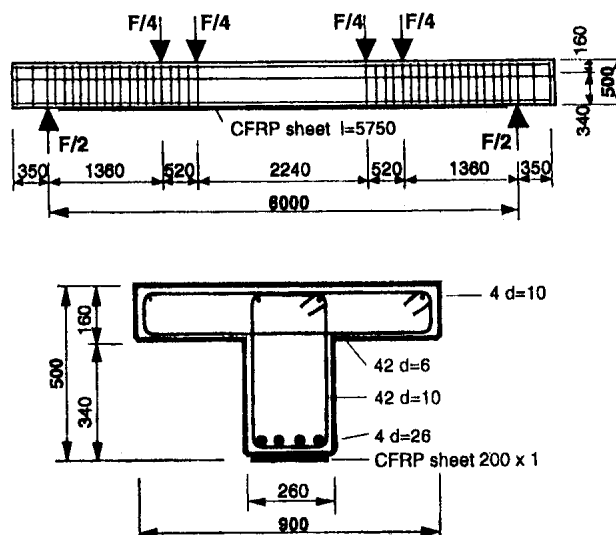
Dimensions des poutres (unité: mm, d'après Clarke, 1993)
